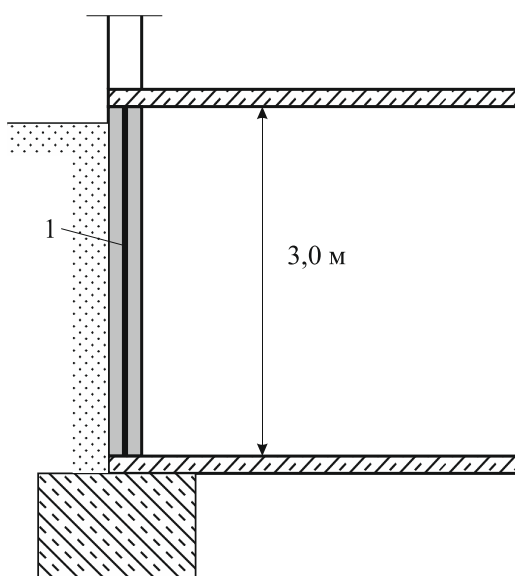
К расчету стены подвала с вертикальной арматурой 1
